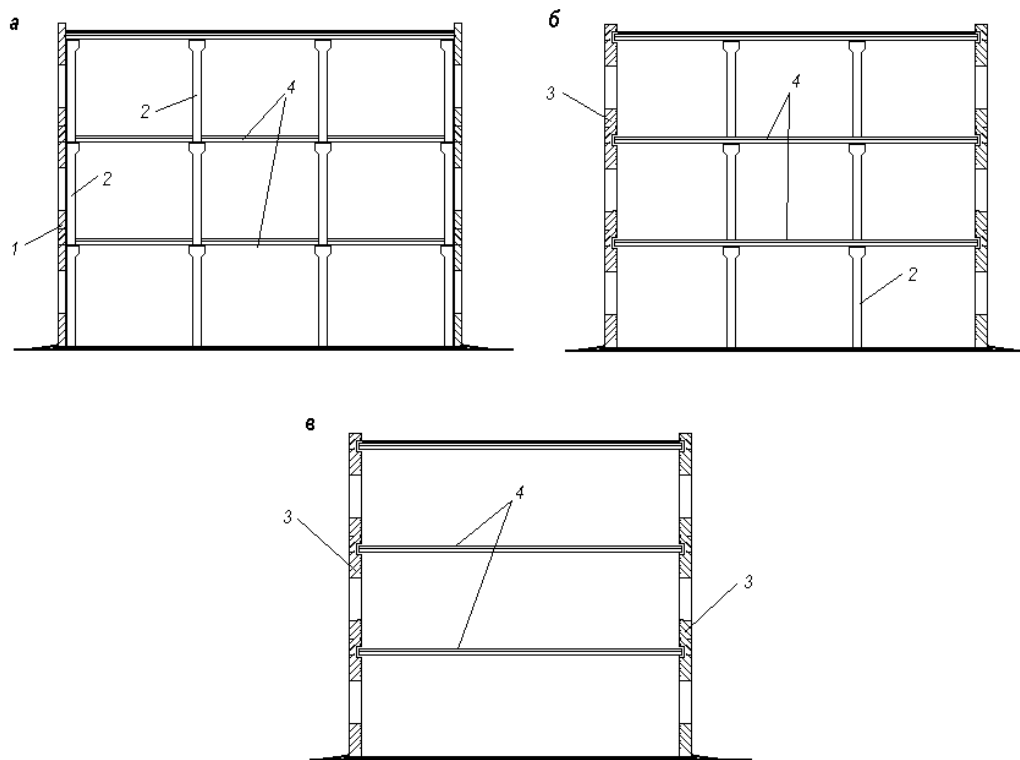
Конструктивні типи багатоповерхових будівель: а – каркасні; б – з неповним каркасом; в – з несучими стінами; 1 – стіна; 2 – колона; 3 – несуча стіна; 4 – перекриття
